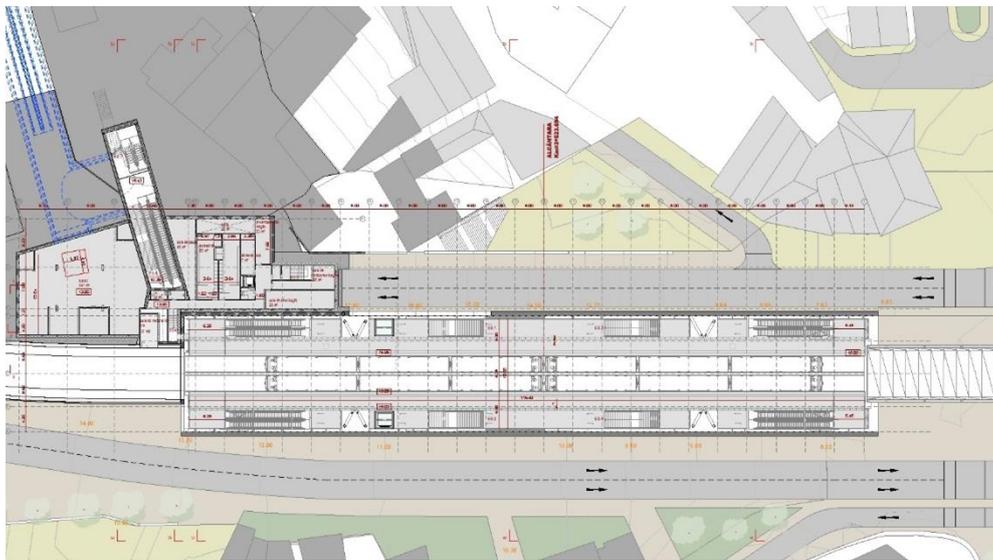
Planta Piso 1 - Cais ML (ML 134351).
